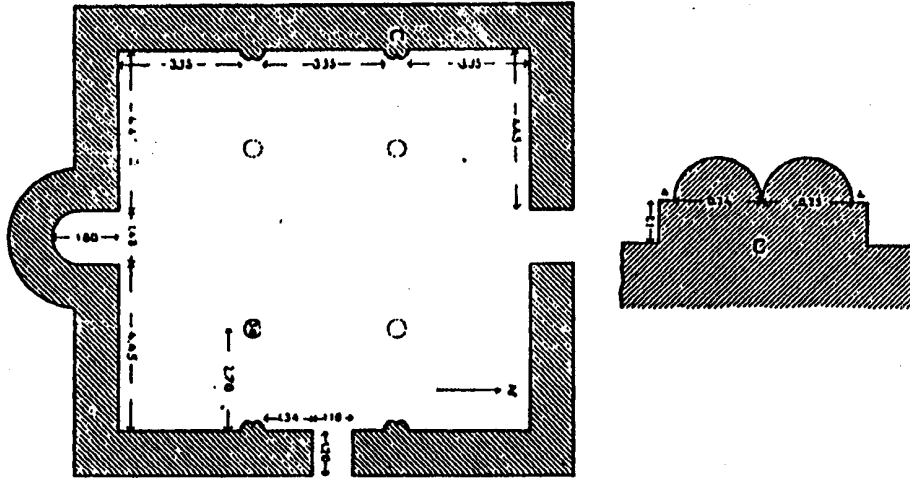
مكرر) مسقط أفقي لمسجد فتيانه بالأندلس (عن : كمال عناني اسماعيل)
